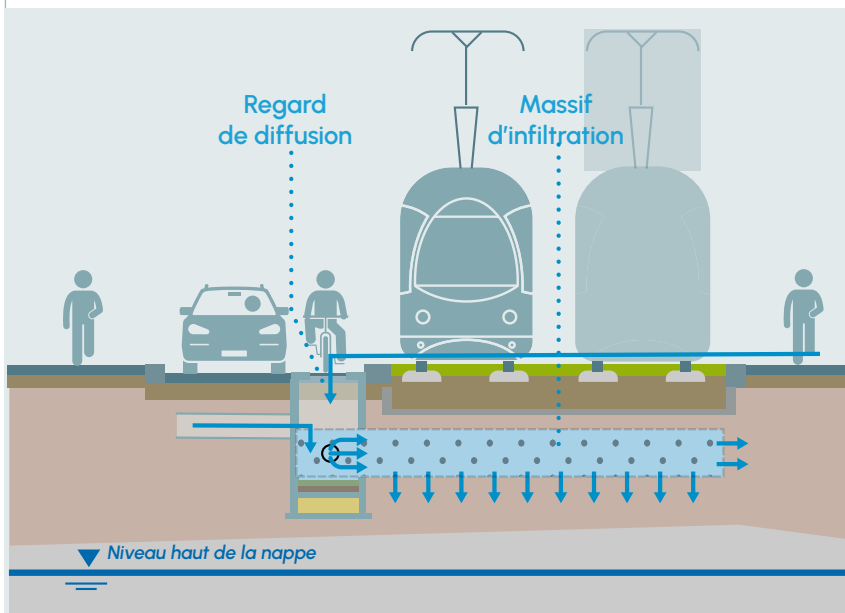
Coupe transversale d'une tranchée d'infiltration plateforme tramway
